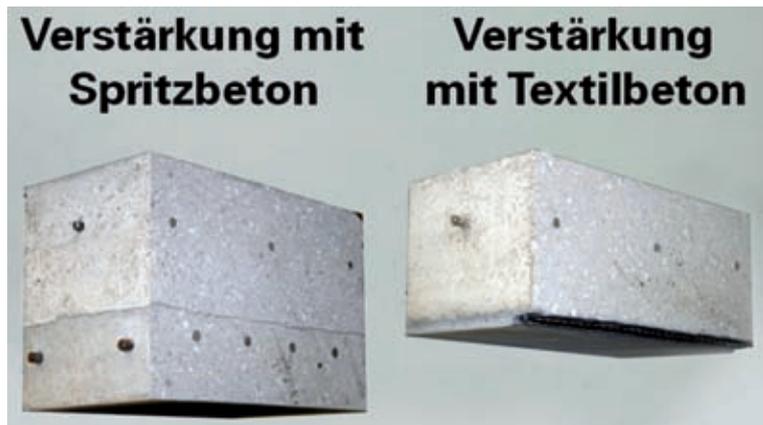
Verstärken im Vergleich Spritzbeton – Textilbeton
